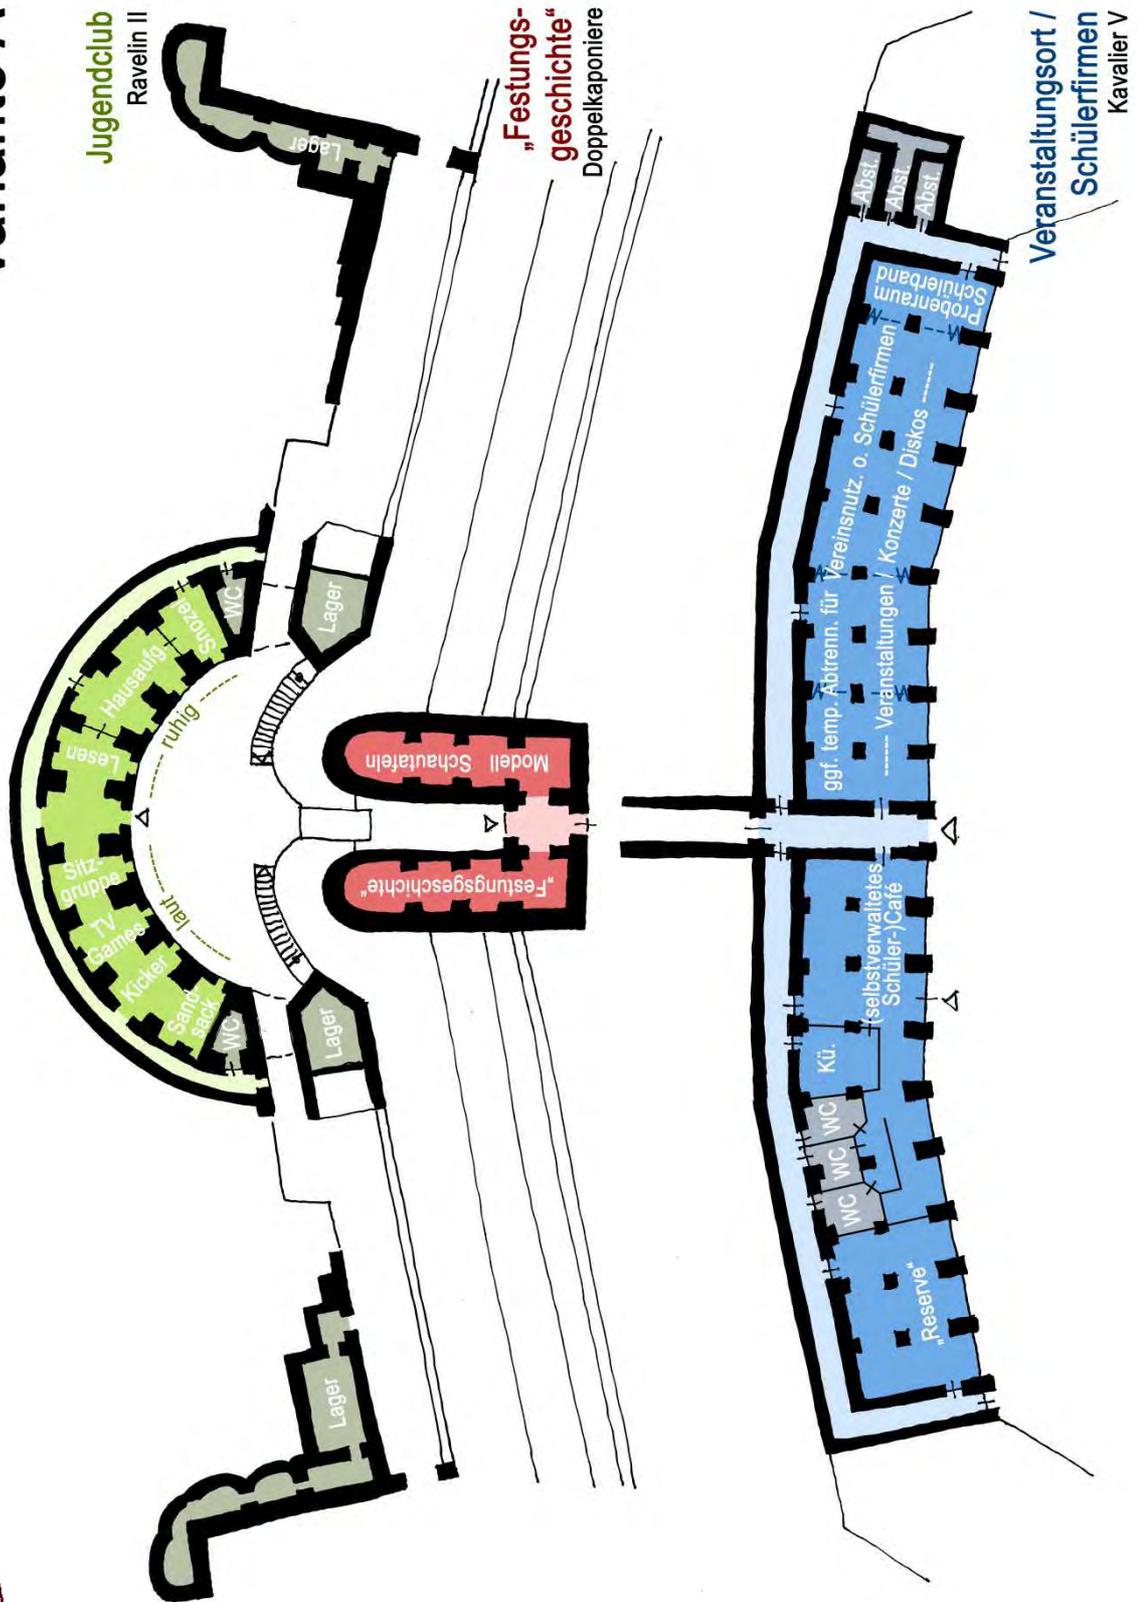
Grundrisskizze / Funktionsschema Variante A
